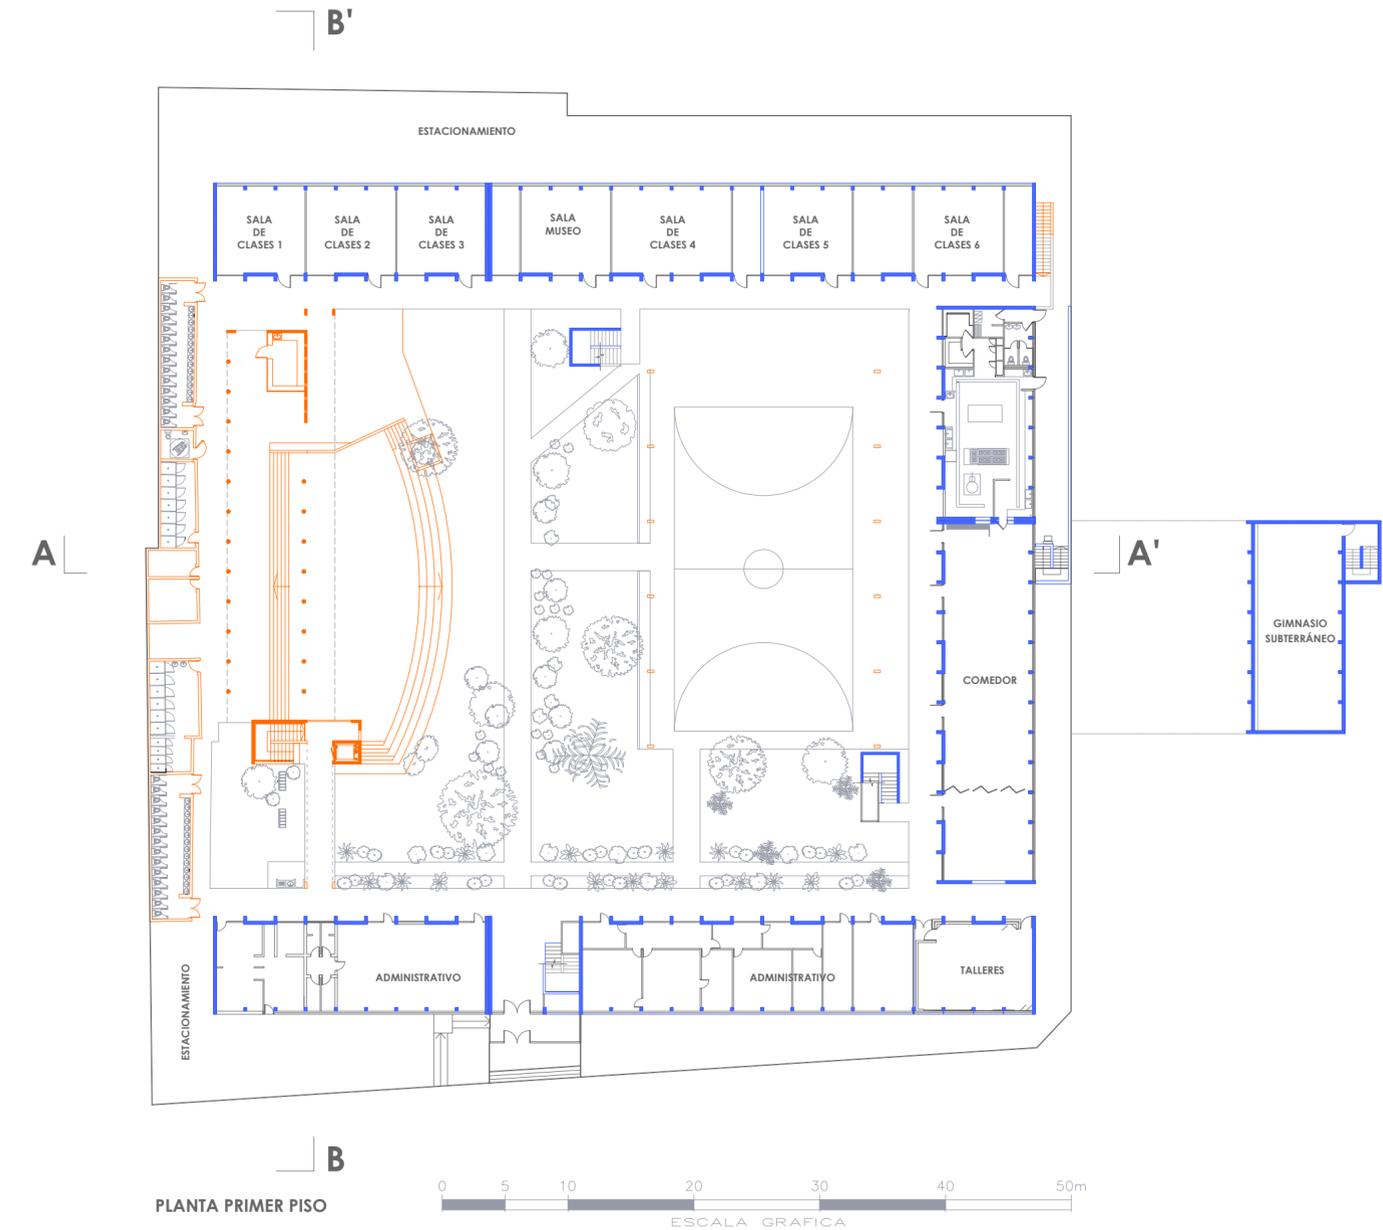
Planta primer piso con preexistencias que se conservan y las que se eliminan. Fuente: Elaboración propia
